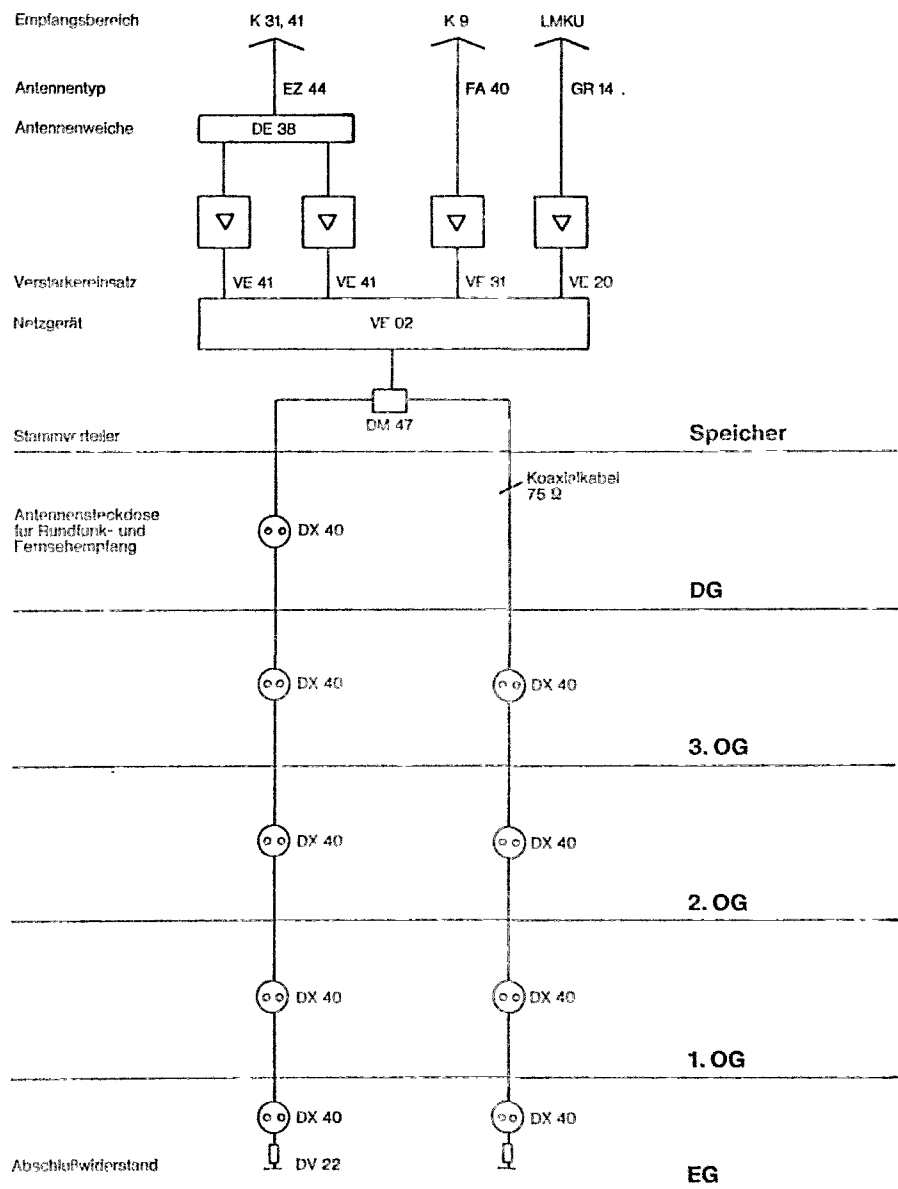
Installationsschema für Rundfunk- und Fernsehempfang. /6/
